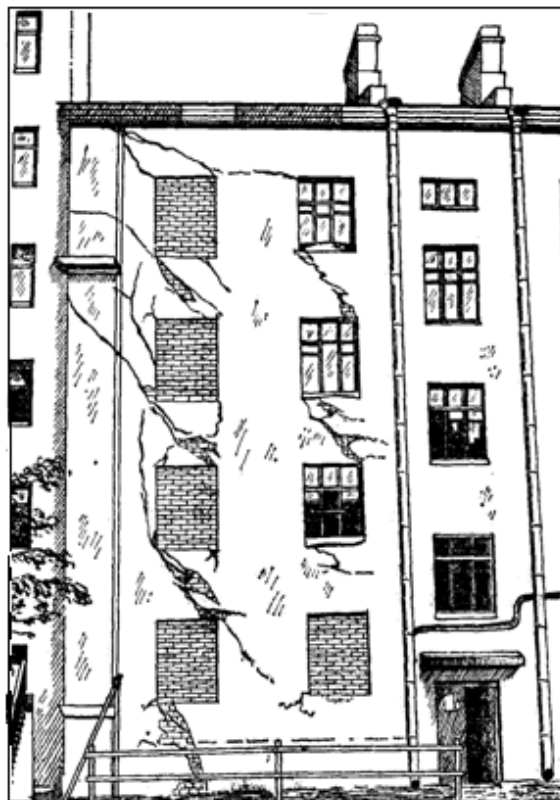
Дефект возведенной стены четырехэтажного строения на ленточных фундаментах, когда было строительство рядом с ним одиннадцатипятиэтажного здания
